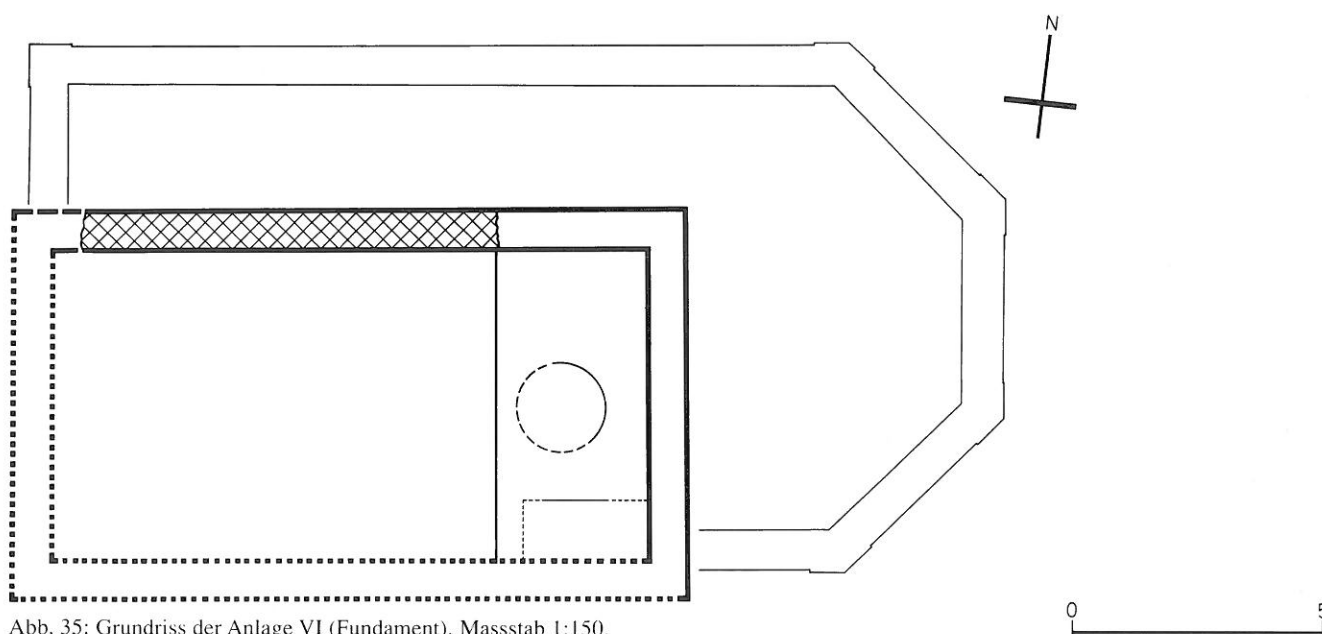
Grundriss der Anlage VI (Fundament). Massstab 1:150.
